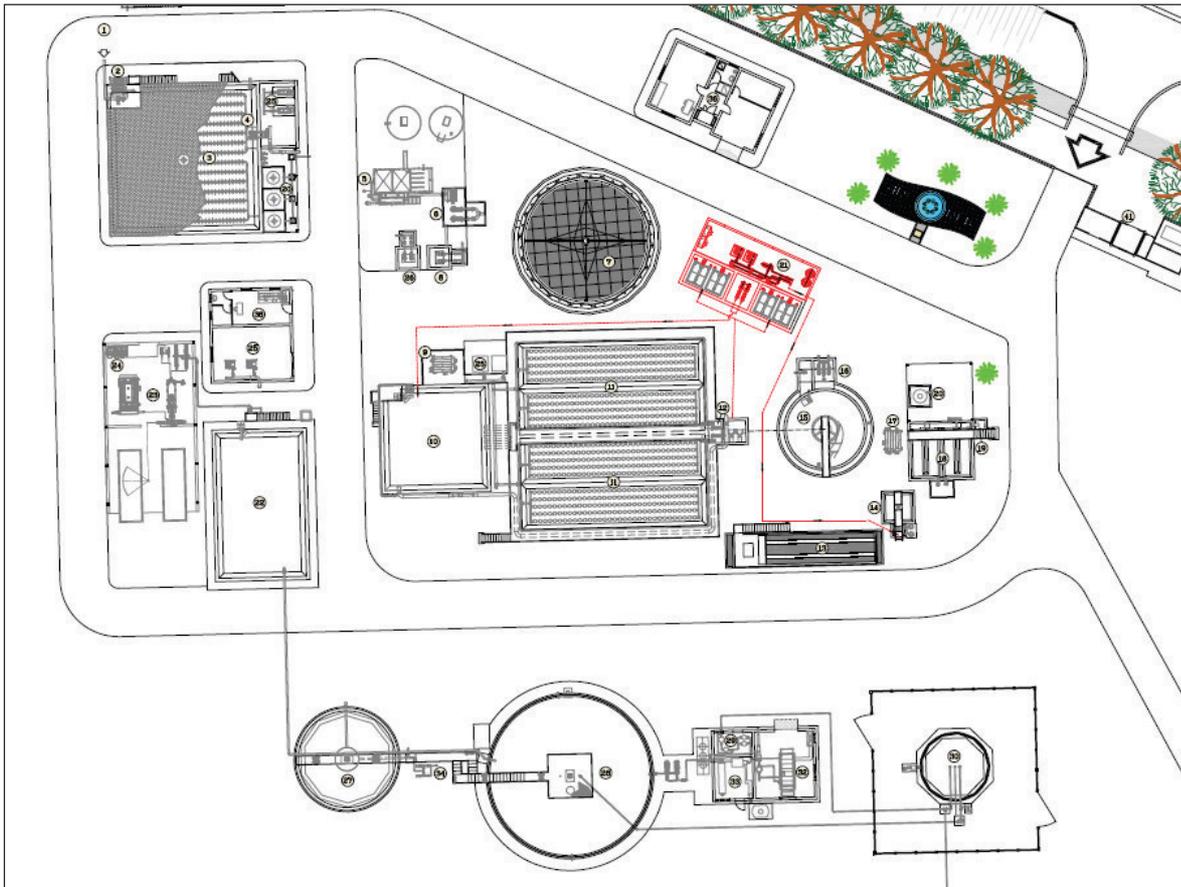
Dettaglio dell'ipotesi c): realizzazione di una nuova sezione di ultrafiltrazione
